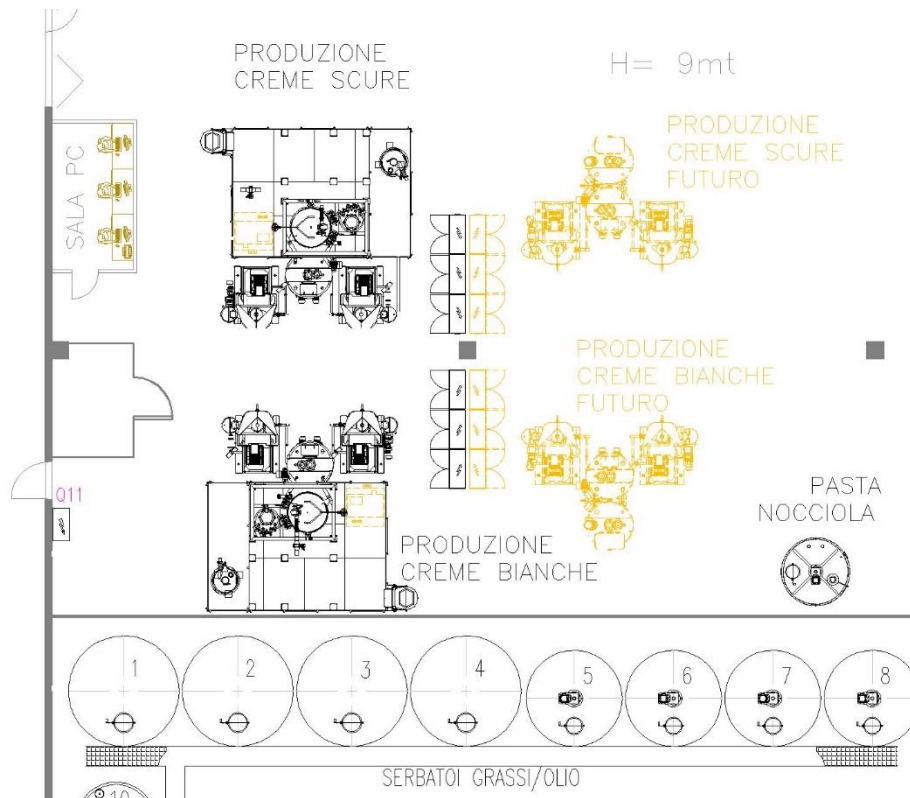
Particolare pianta (Autocad) in cui si mette in evidenza il posizionamento delle macchine future per la produzione delle creme (in giallo)
